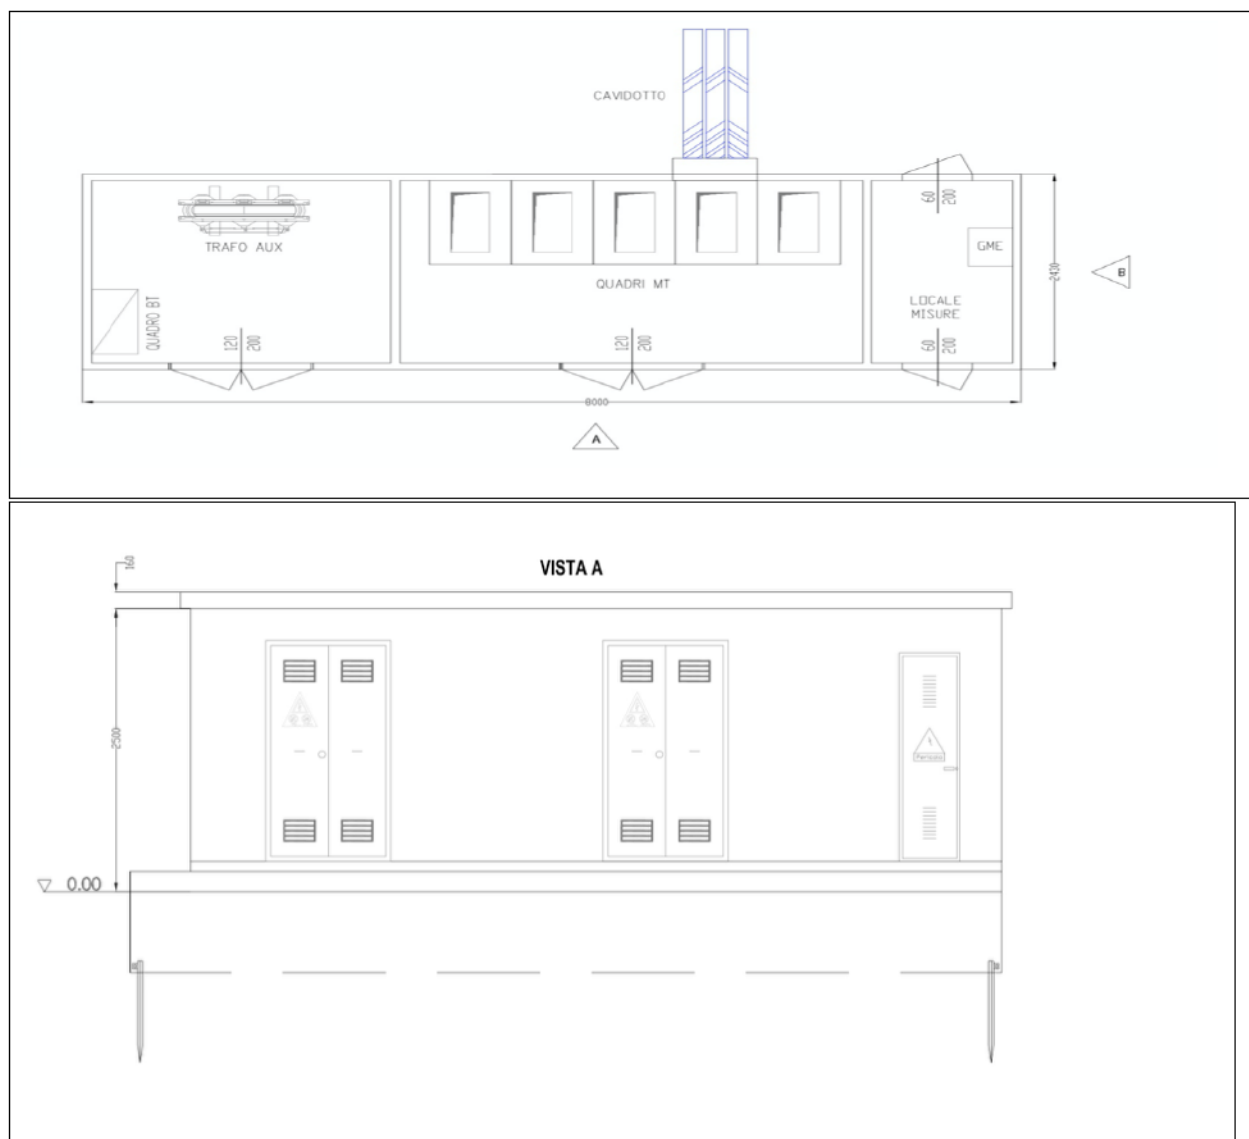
Locale cabina di Parallelo Mt-Prospetto
